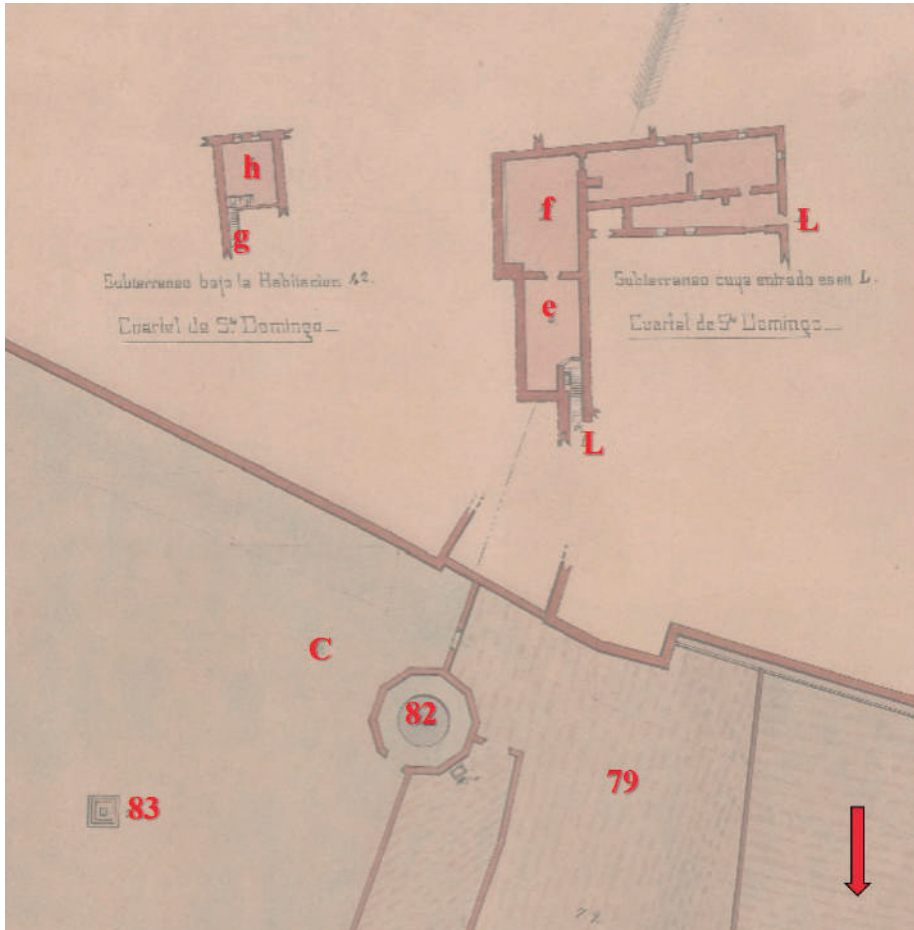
Detalle de la planta baja del edificio. Zona norte del conjunto de San Esteban de Salamanca. AGMM, Cartoteca, SA-3/14. Montaje del autor.
